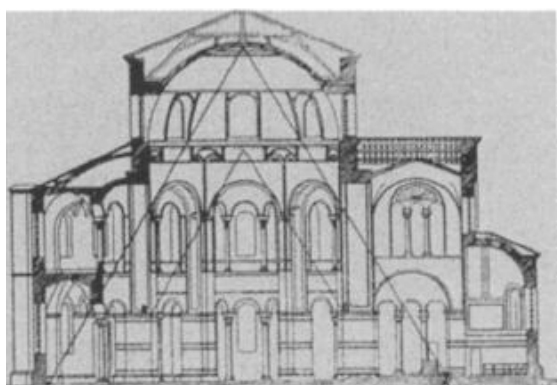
Ravenna, San Vitale. Sezione. Secondo KLEINBAUER 1965.
